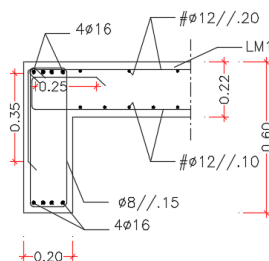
Vista em Alçado da ligação entre as duas estruturas
